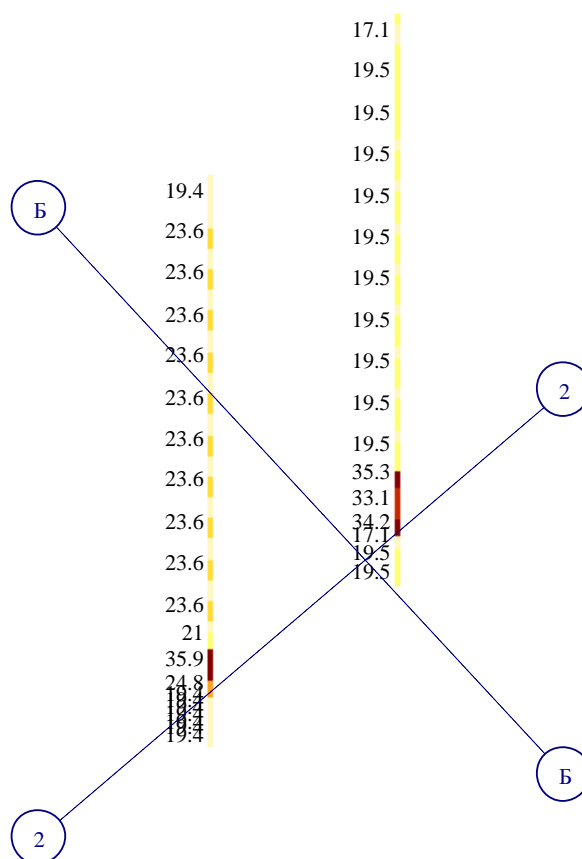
Площадь армирования колонн осях А/2 и Б/2
